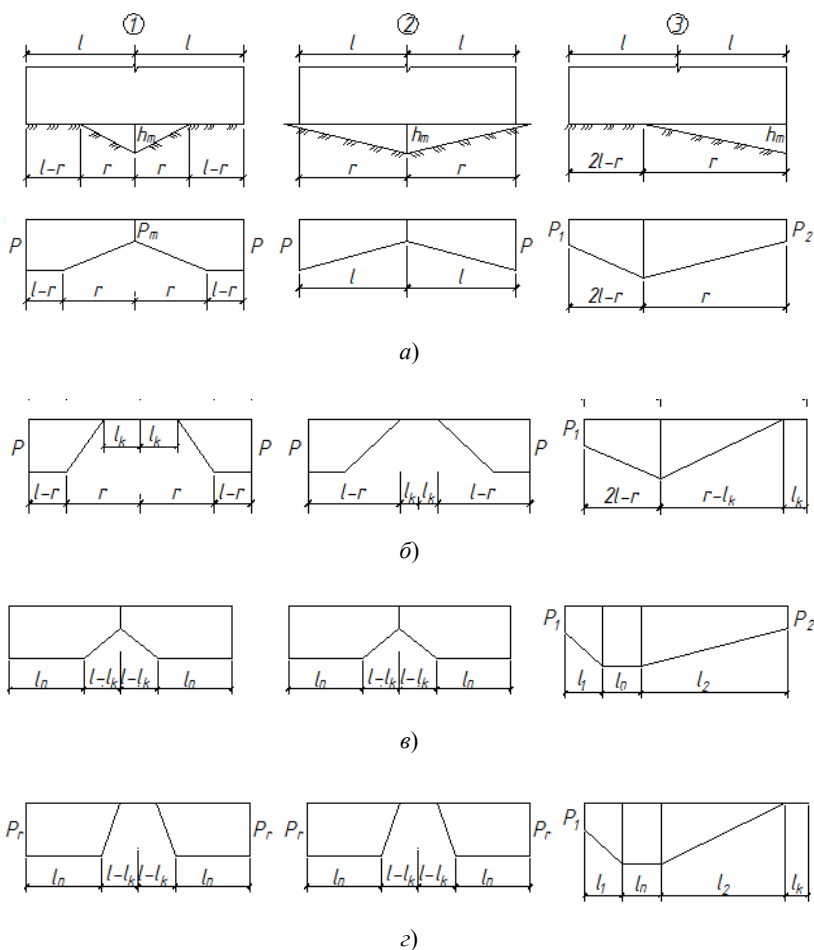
Эпюры отпора основания при расчете зданий на просадочных грунтах II типа при расположении центра просадочной воронки:
